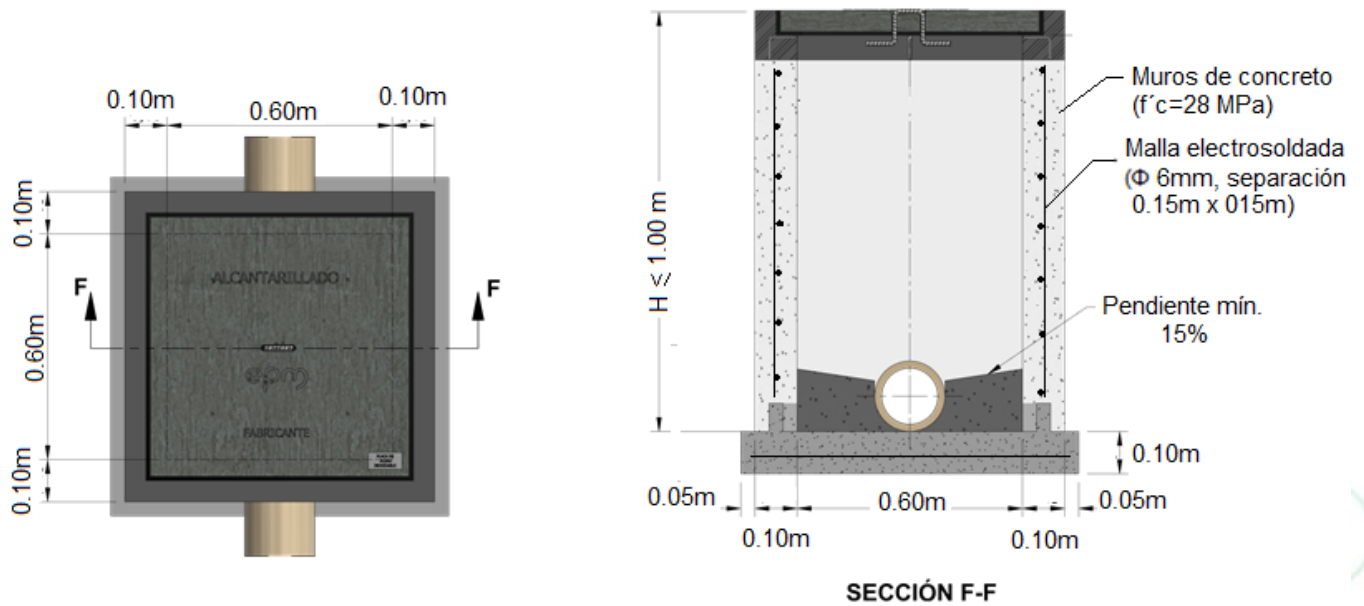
Caja de inspección tipo 1 – Planta y sección transversal
